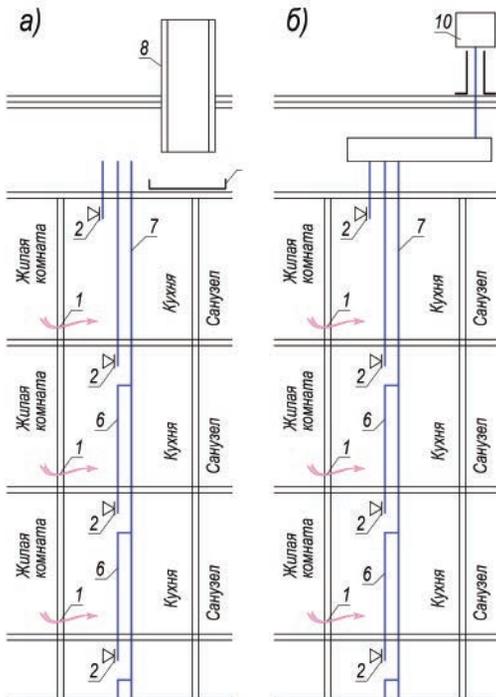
Система естественной вентиляции зданий более пяти этажей:
